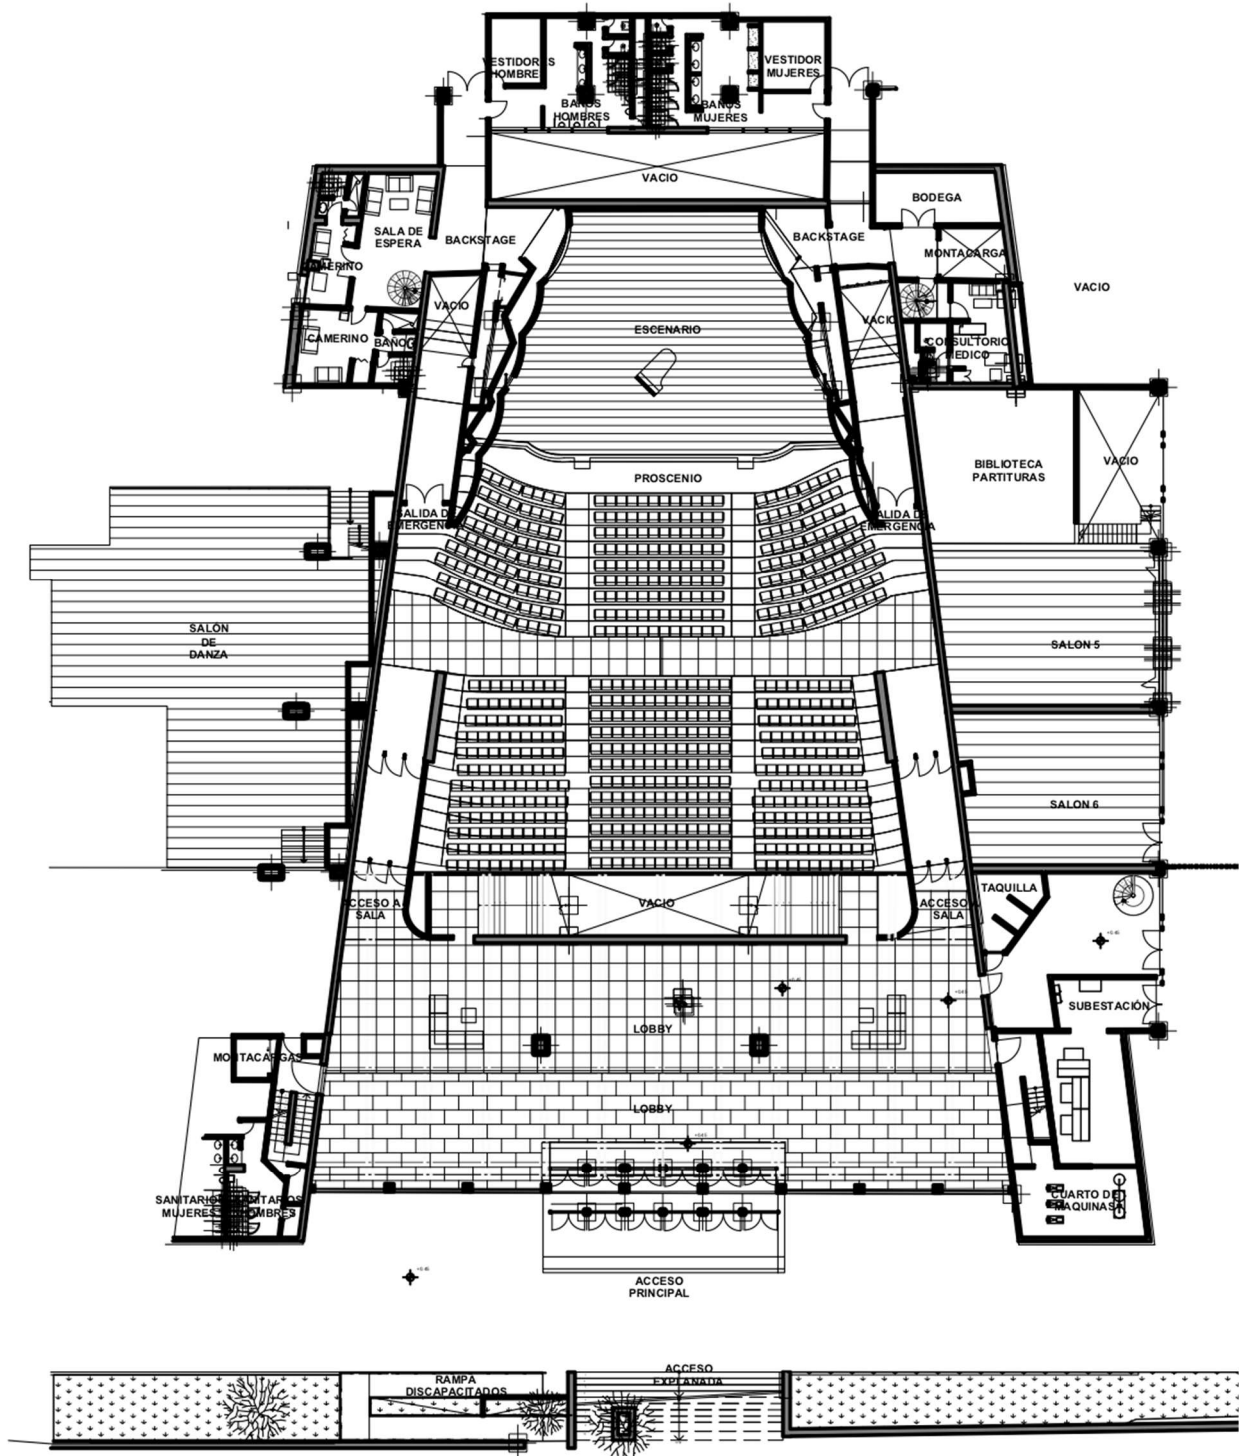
Plano Arquitectónico Sala Silvestre Revueltas
